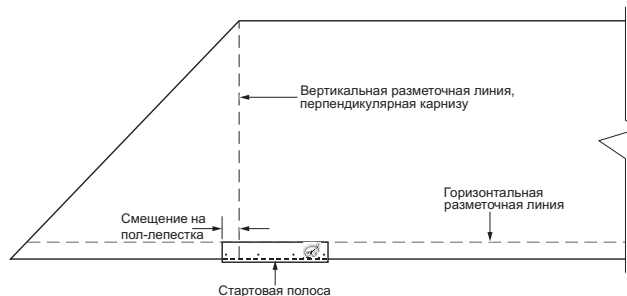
Разметка шатровой кровли и установка стартовой полосы
